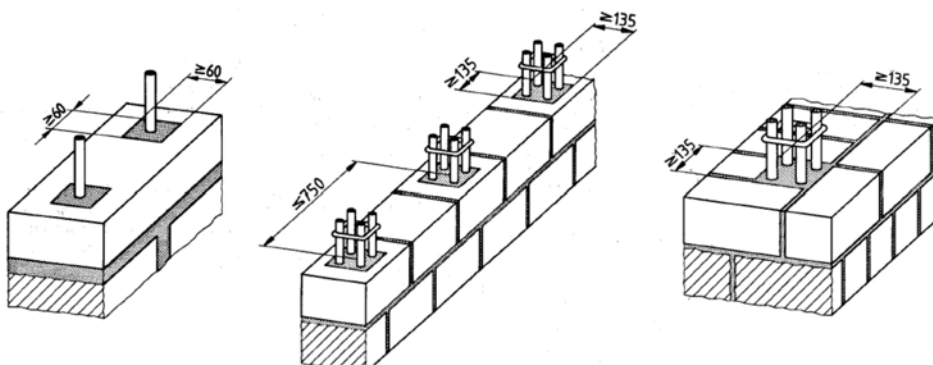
Vertikale Bewehrungsführung nach DIN 1053-3 /X1/
